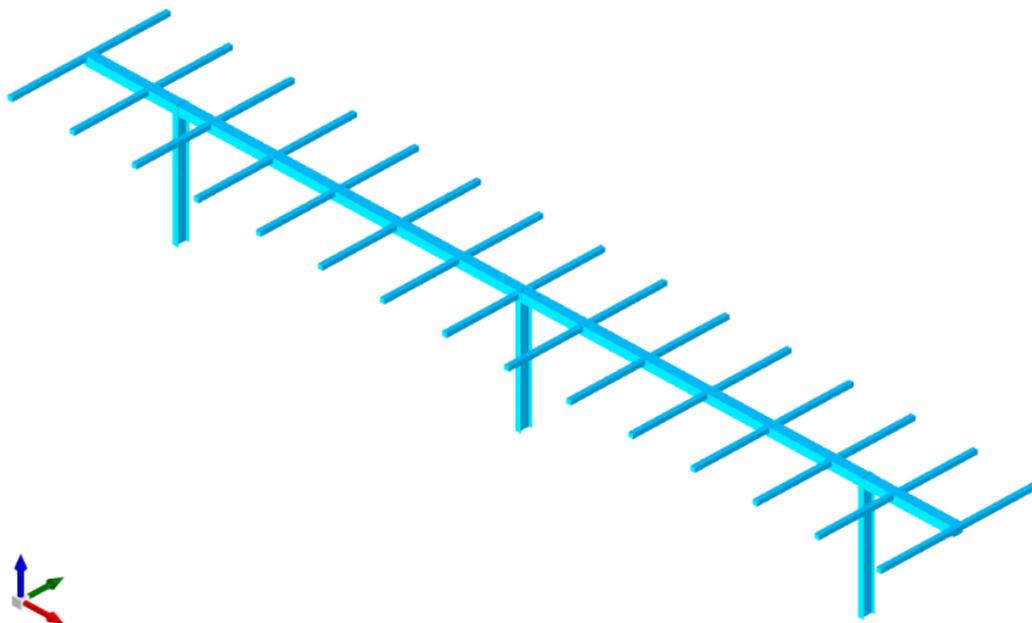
Vista assonometrica modello strutturale con posizione della “vela” orizzontale
